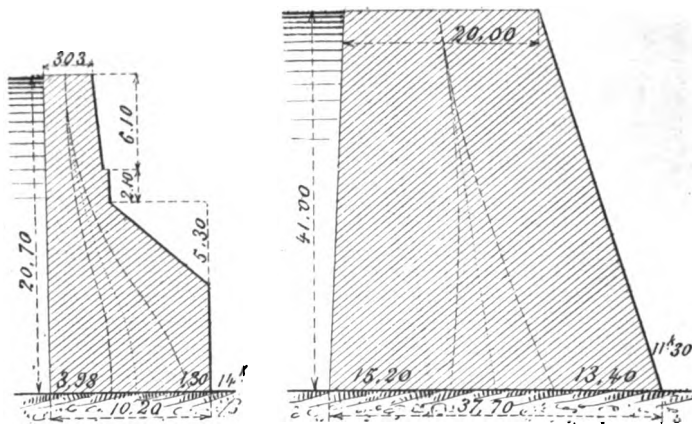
et 66. — Courbes des pressions des barrages d'Almanza et d'Alicante.
